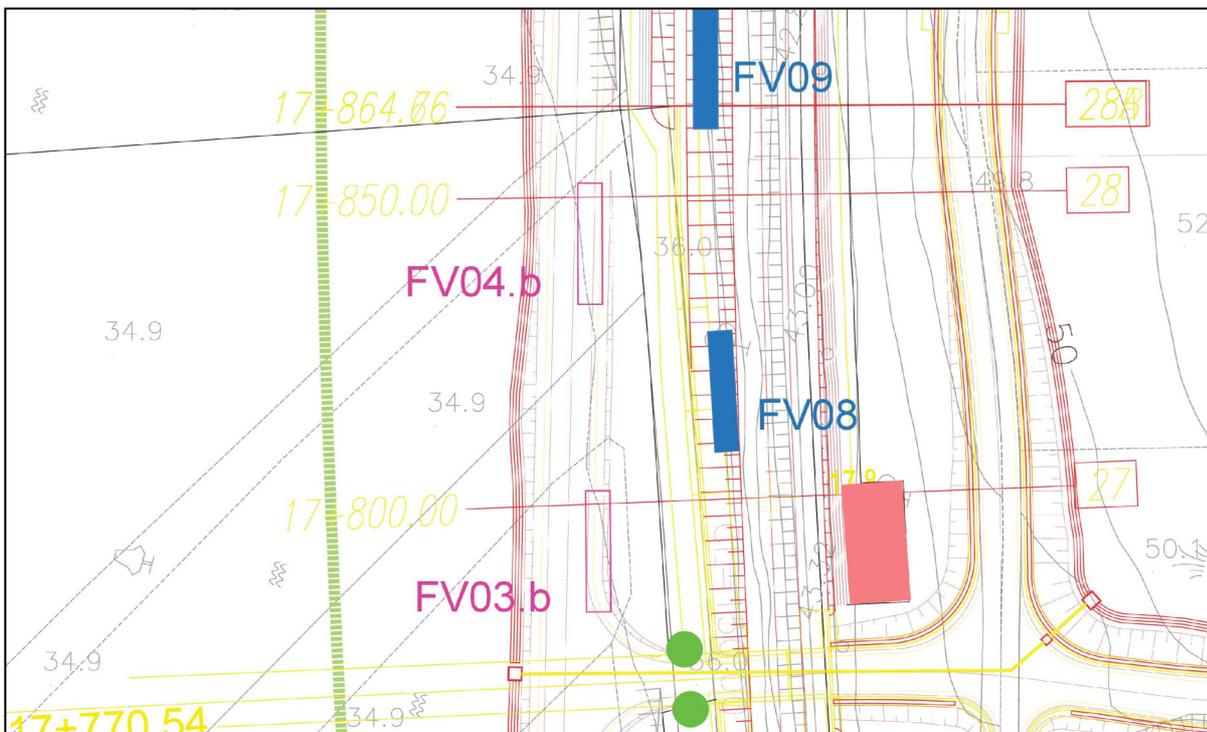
Stralcio planimetrico con l'ubicazione dei sondaggi integrativi FV03b e FV04b
